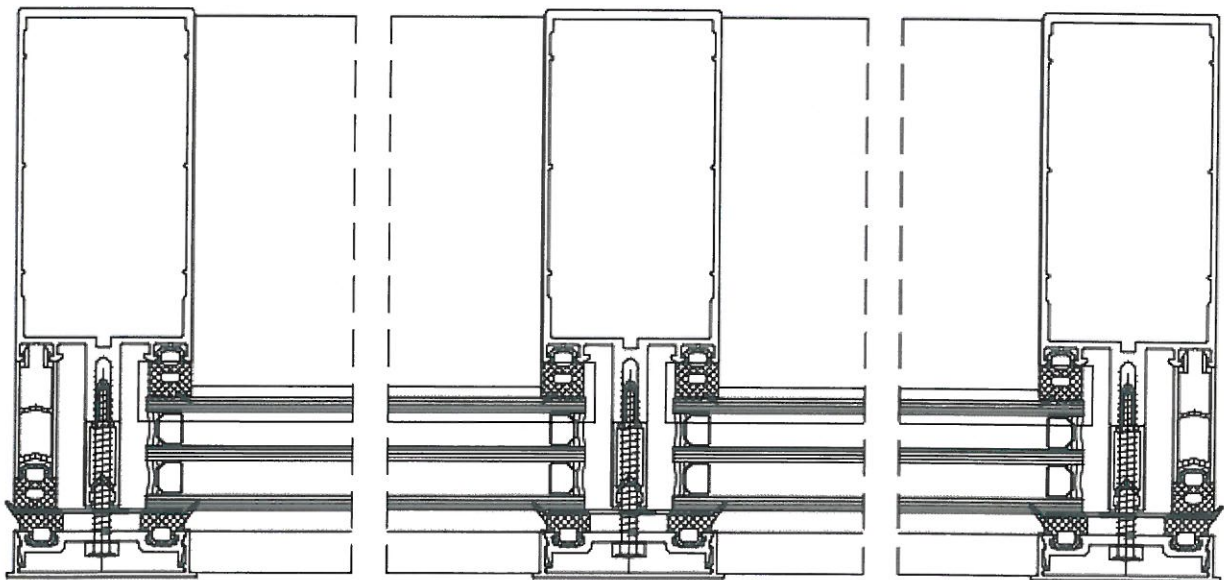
Горизонтальный разрез испытываемой конструкции.
